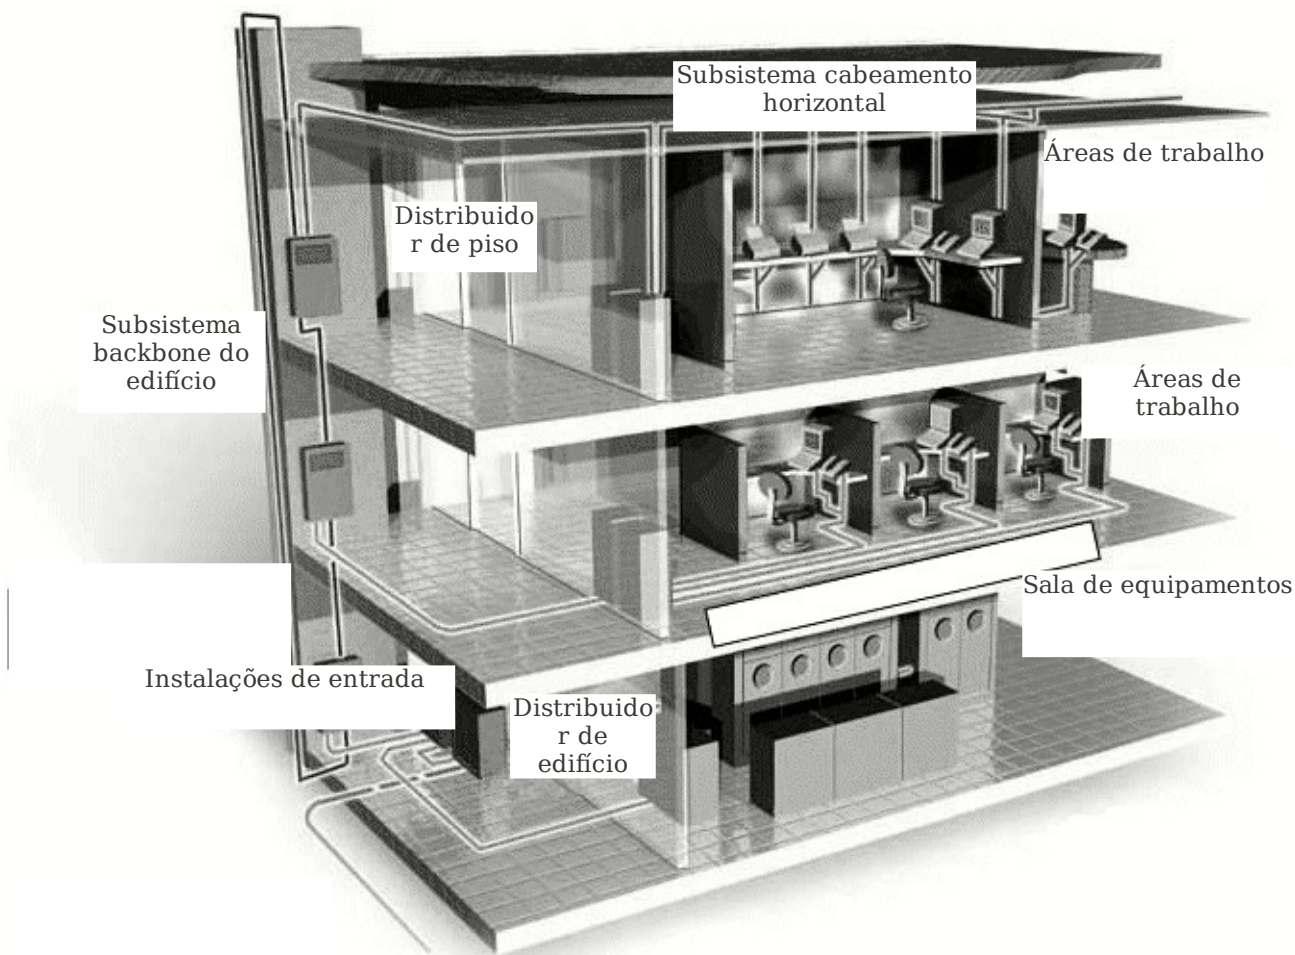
Exemplo de uma instalação de cabeamento estruturado.
